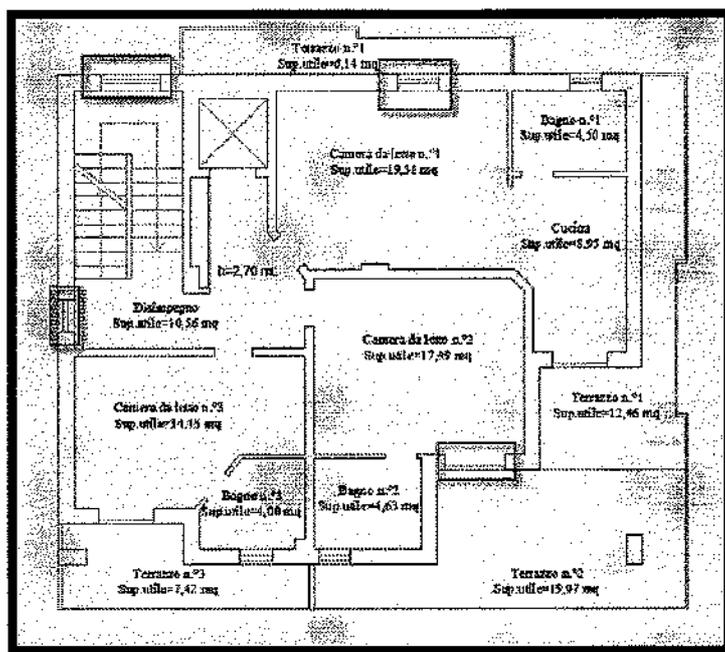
Pianta piano primo – Rilievo eseguito in occasione dei sopralluoghi
